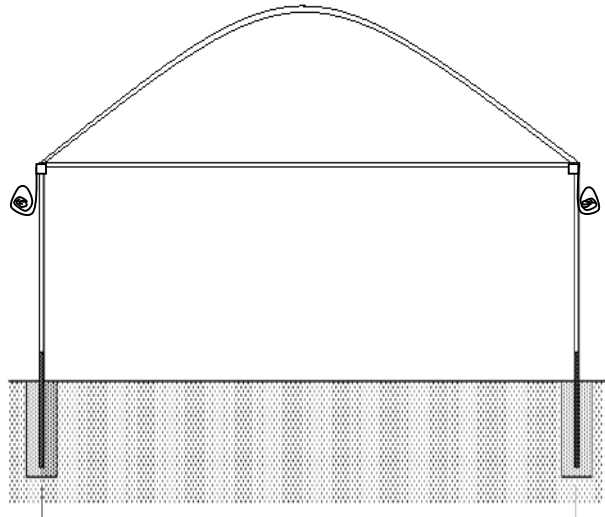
Serra a tunnel con struttura leggera a tubi metallici. scala 1:100
